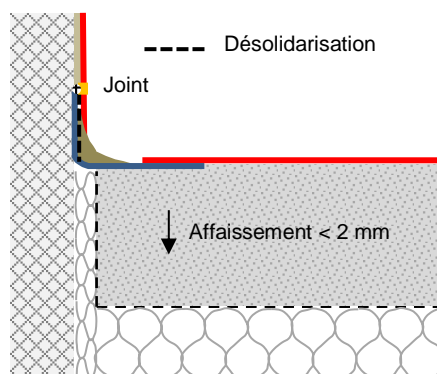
Jonction de joint entre la chape et le mur avec bande de joint en boucle et masse d'étanchéité pour joints.
